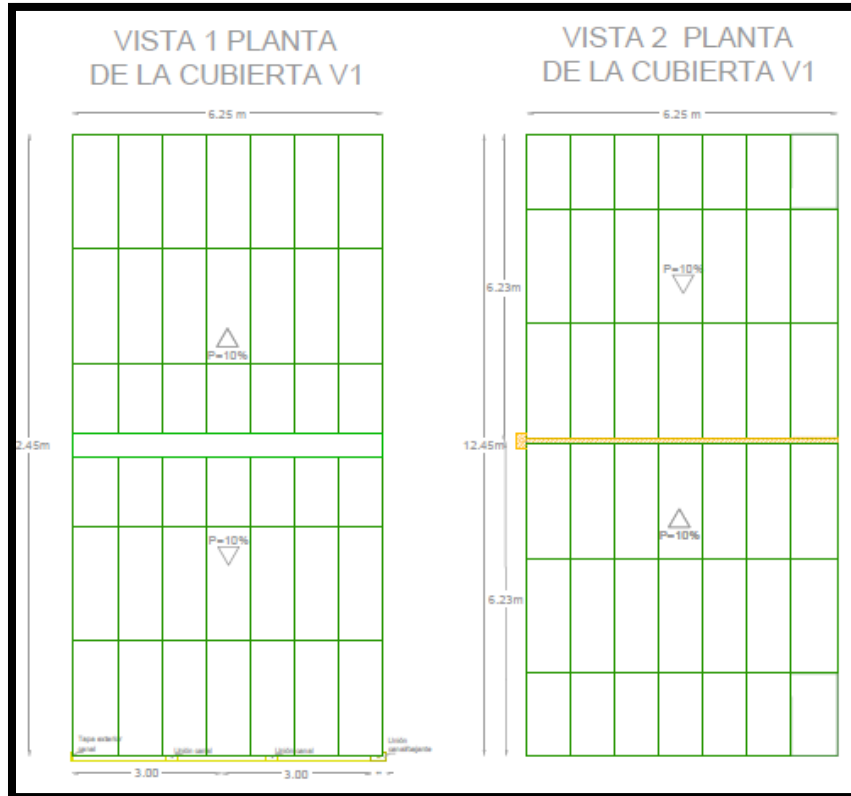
Alternativas de cubierta vivienda 1 (Limatesa y limahoya)
